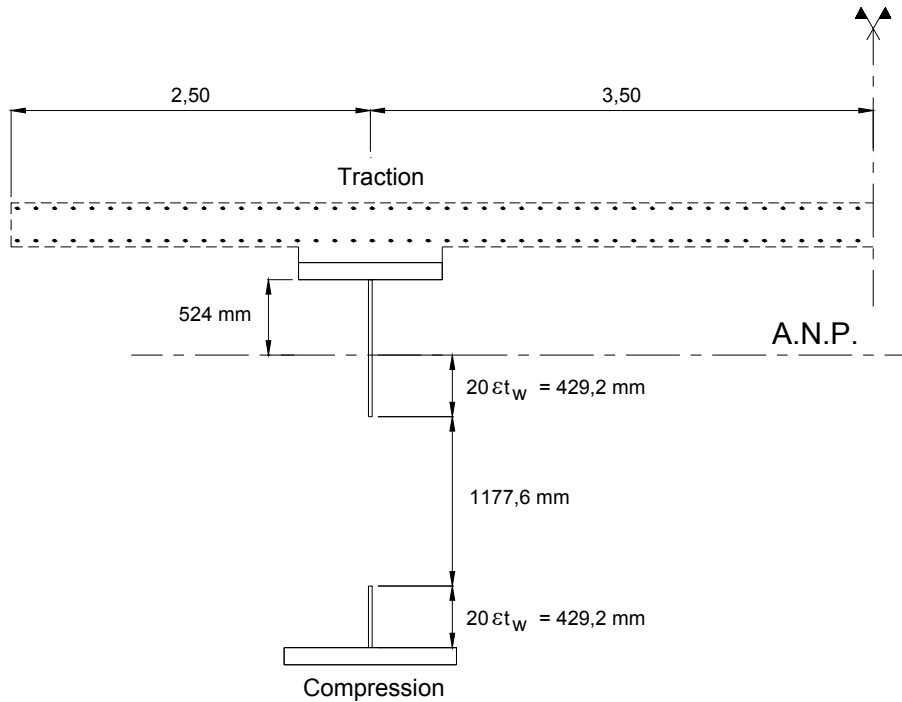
8 : Reclassement en classe 2 efficace de la section sur (P1)
